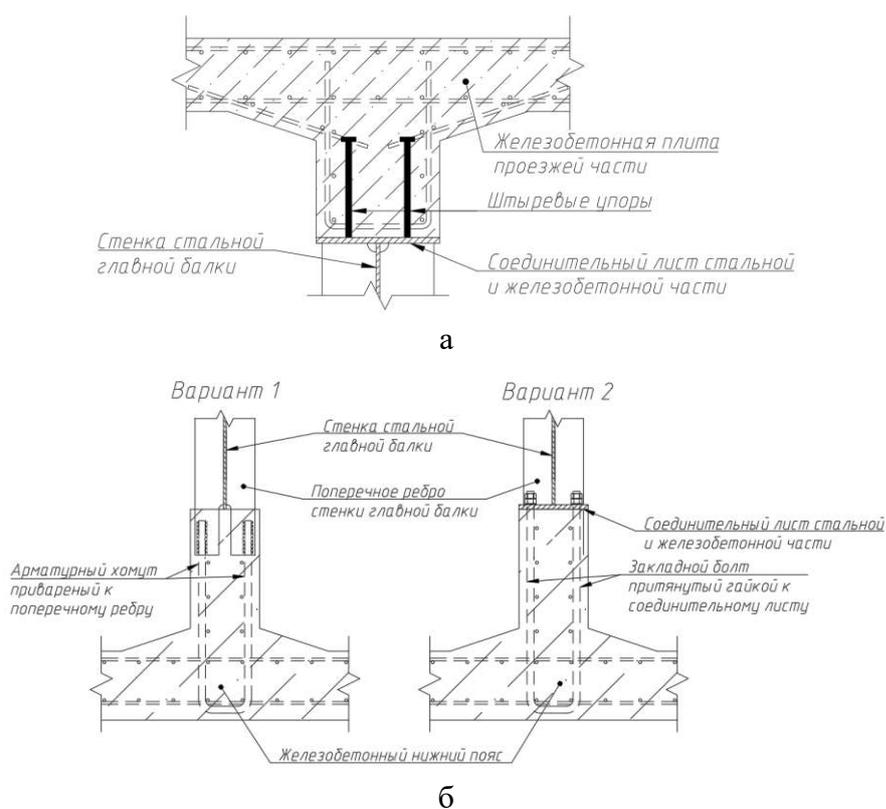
Возможные варианты узлов объединения стальной и железобетонной части:
